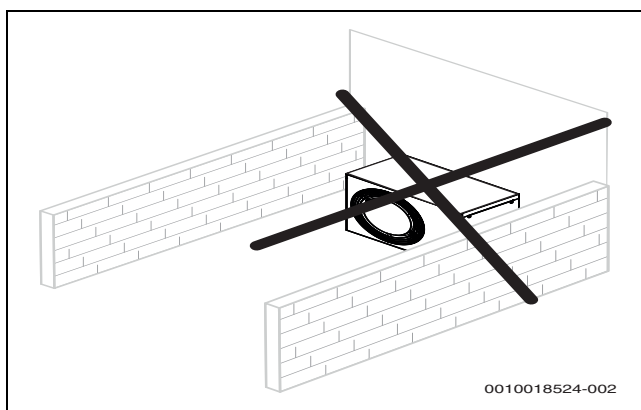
Не устанавливайте тепловой насос в окружении стен
